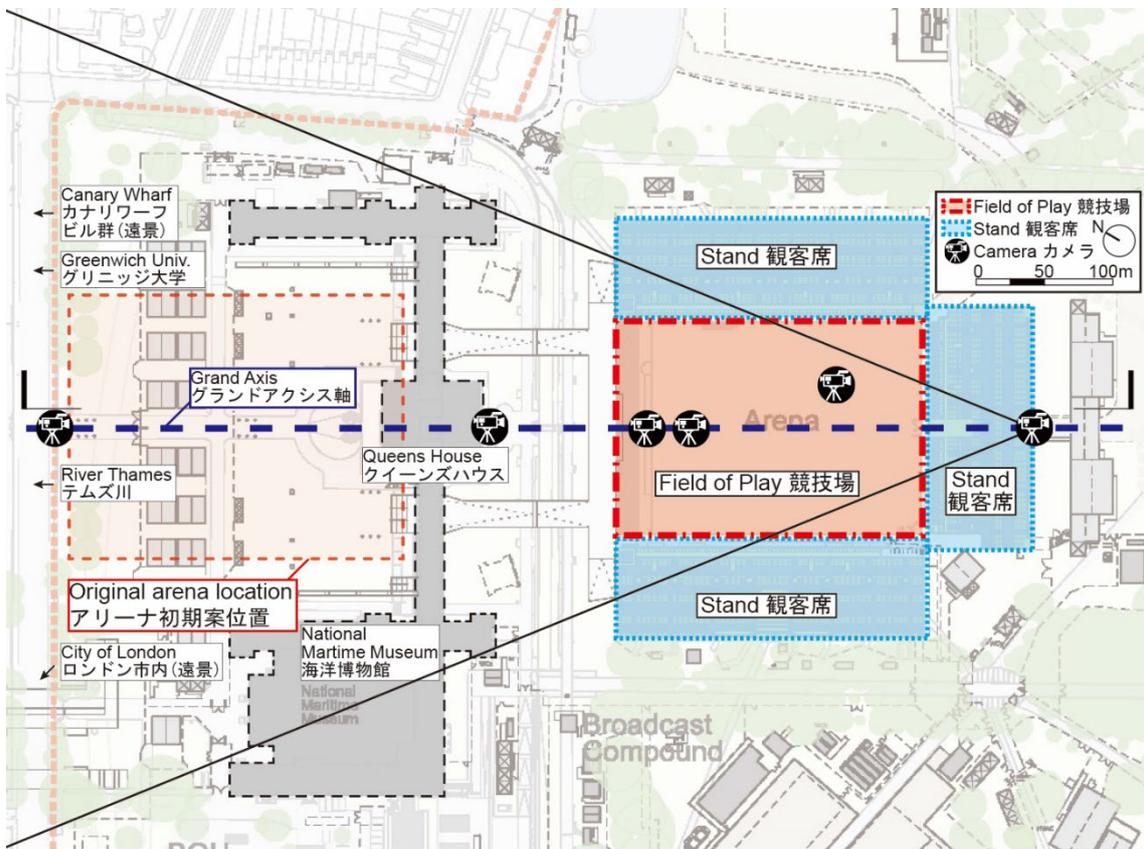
グリニッジ・パーク馬術競技会場 平面配置図
